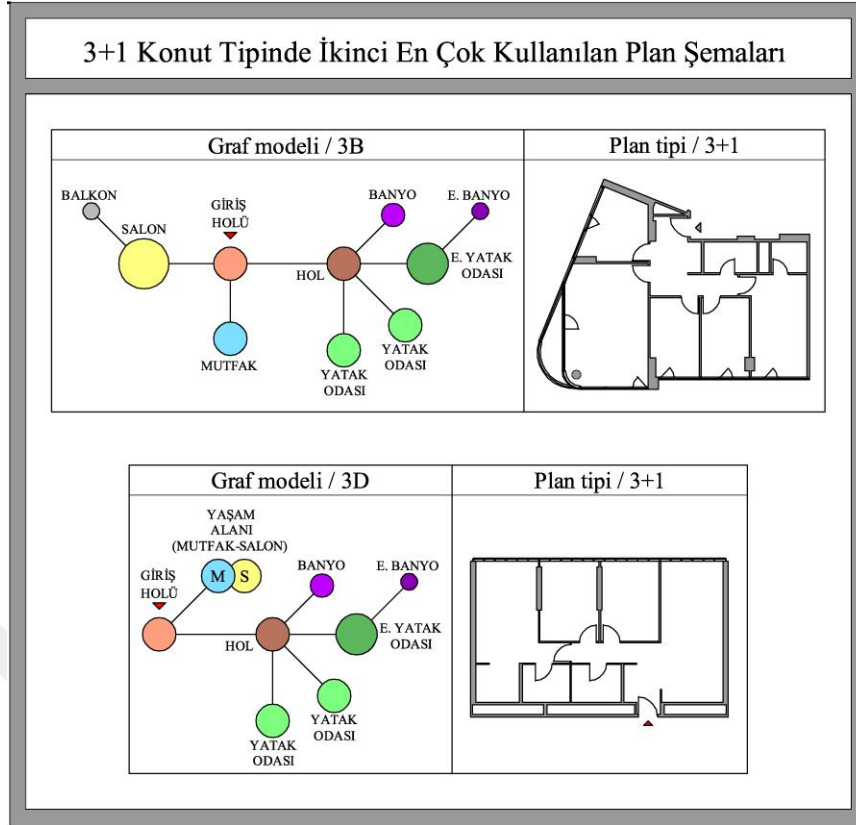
3+1 Konut tipinde en çok kullanılan plan şemaları
